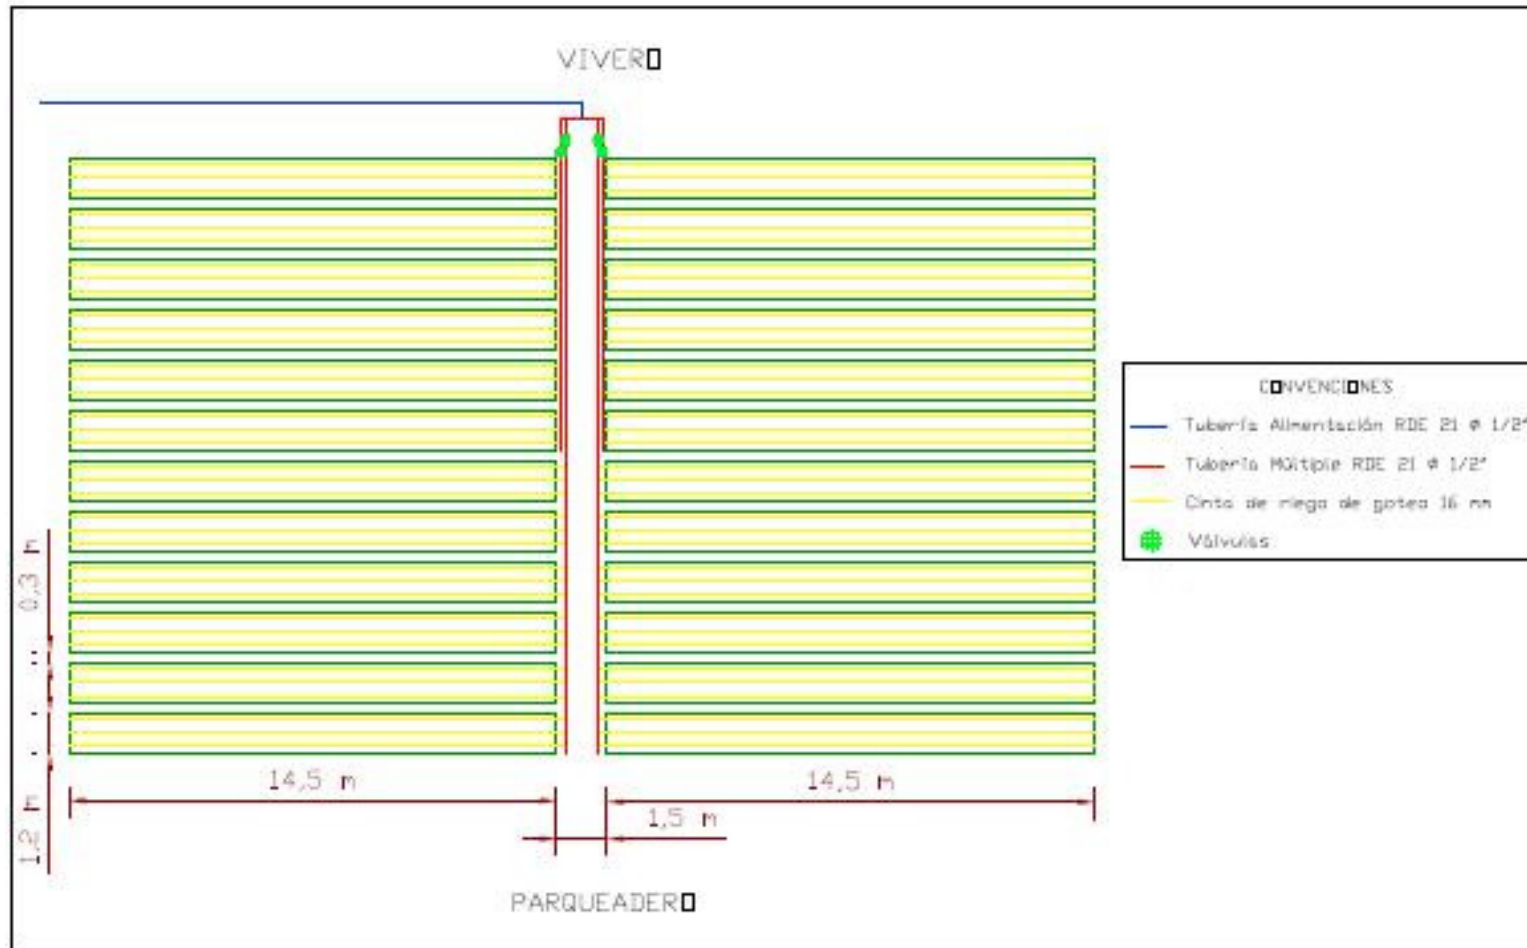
Vista en planta sistema de riego por goteo, hortalizas
